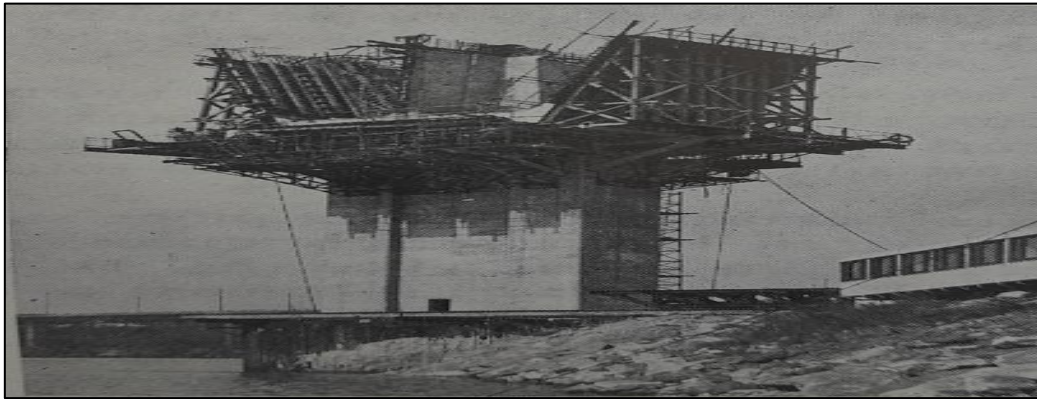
Console en béton remplaçant l'échafaudage du voussoir sur pile
